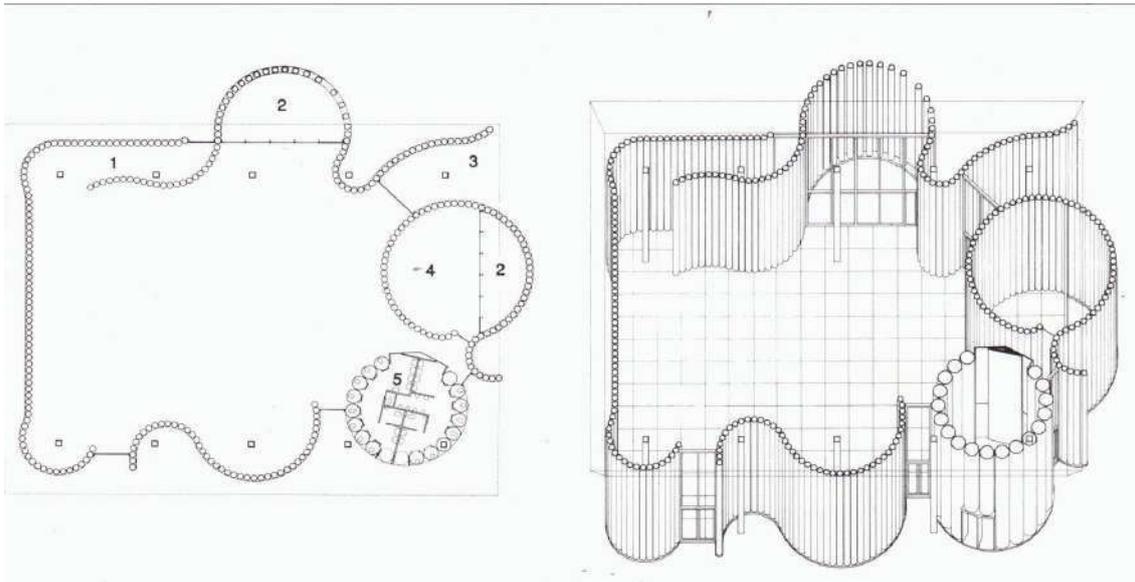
Planta y axonometría pabellón Odawara. Disponible en: <http://estructurasmemarlar.blogspot.com/2011/05/analisis-del-objeto-arquitectonico.html>
